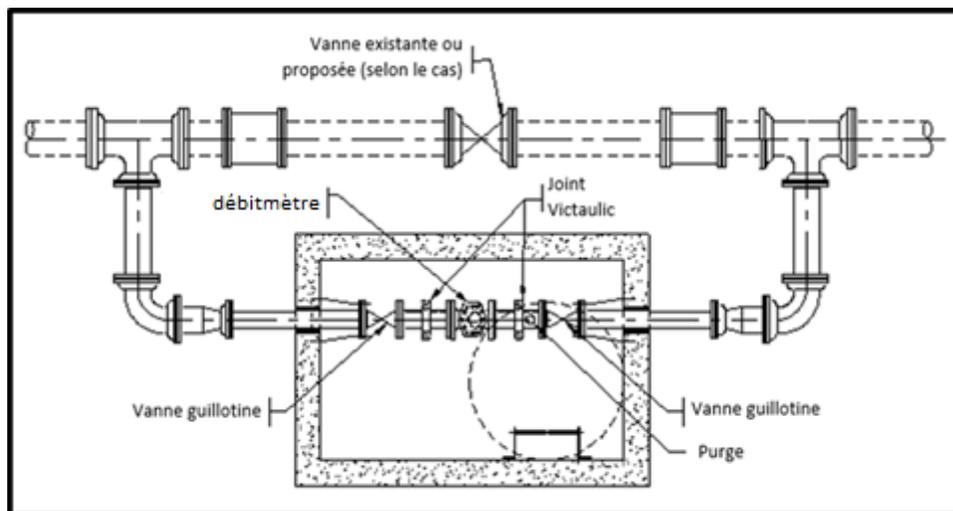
Installation d'un débitmètre sur une conduite en dérivation
